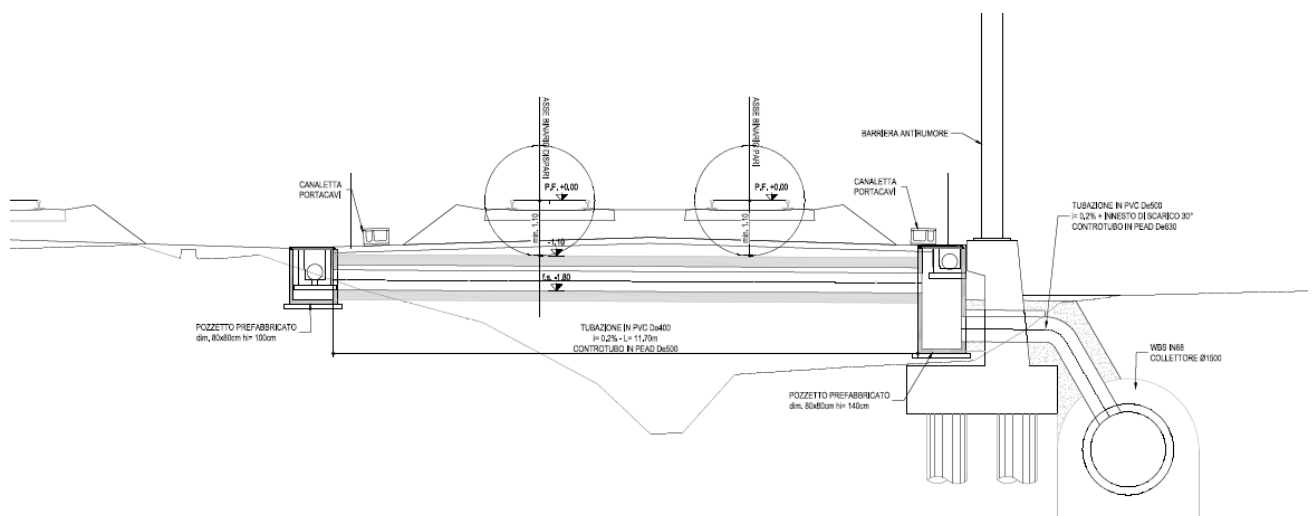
Sezione del rilevato RI84 con scarico nello scolo Altavilla
